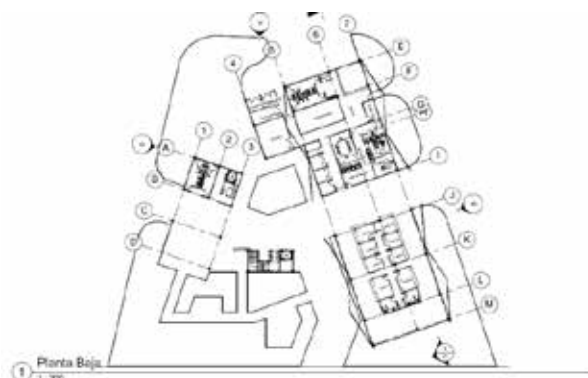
Imagen de Planta baja conjunto del Centro de Artes Plásticas. *Rodríguez y otros (2017)
